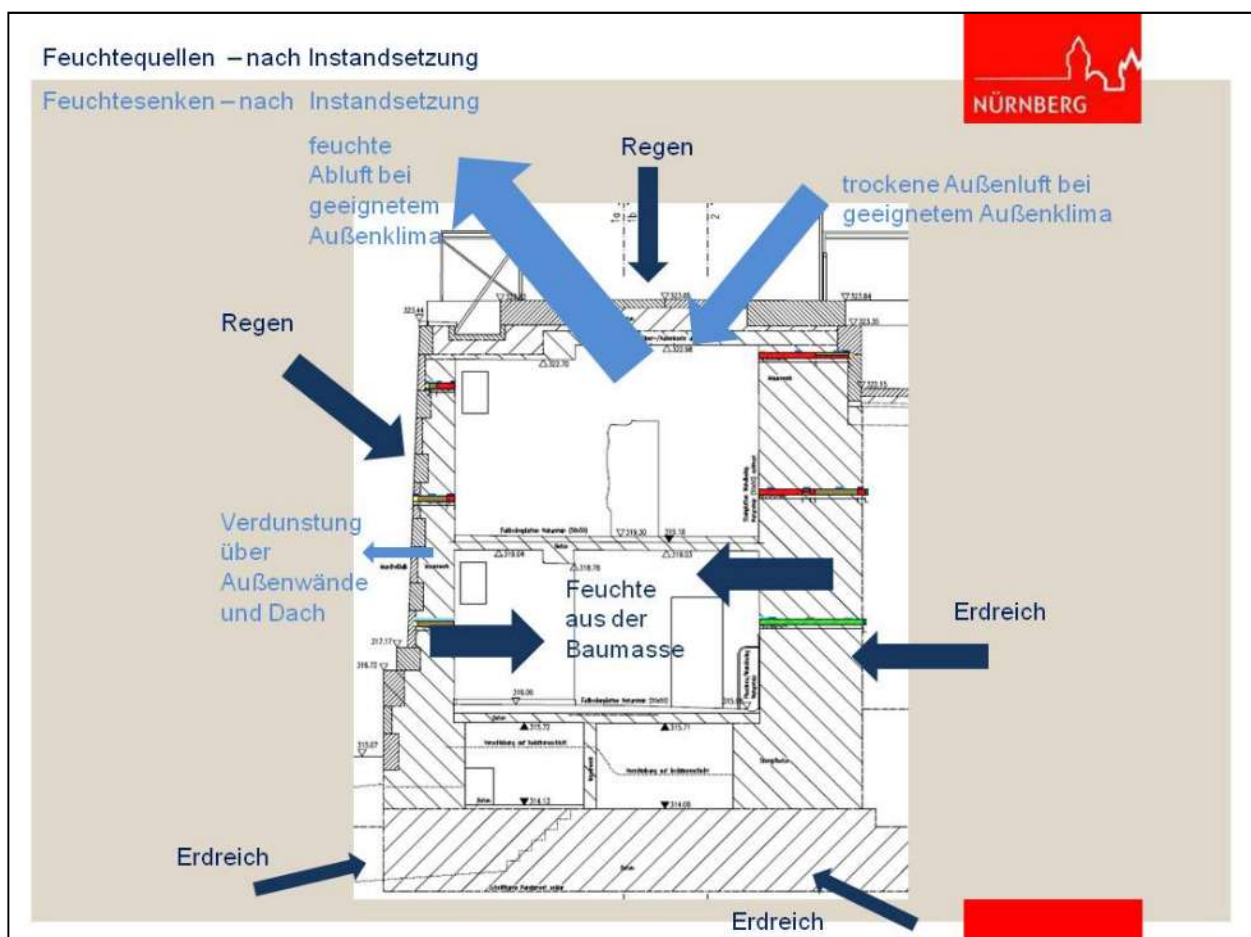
Prinzipskizze Feuchtequellen und Feuchtesenken nach der Instandsetzung
